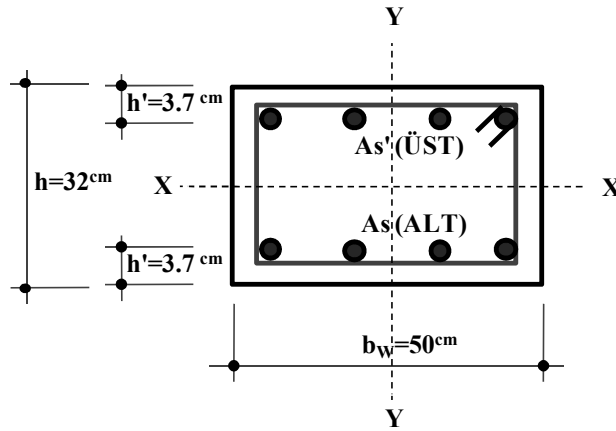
4KÇB'de Tipik Kolon Detayları
